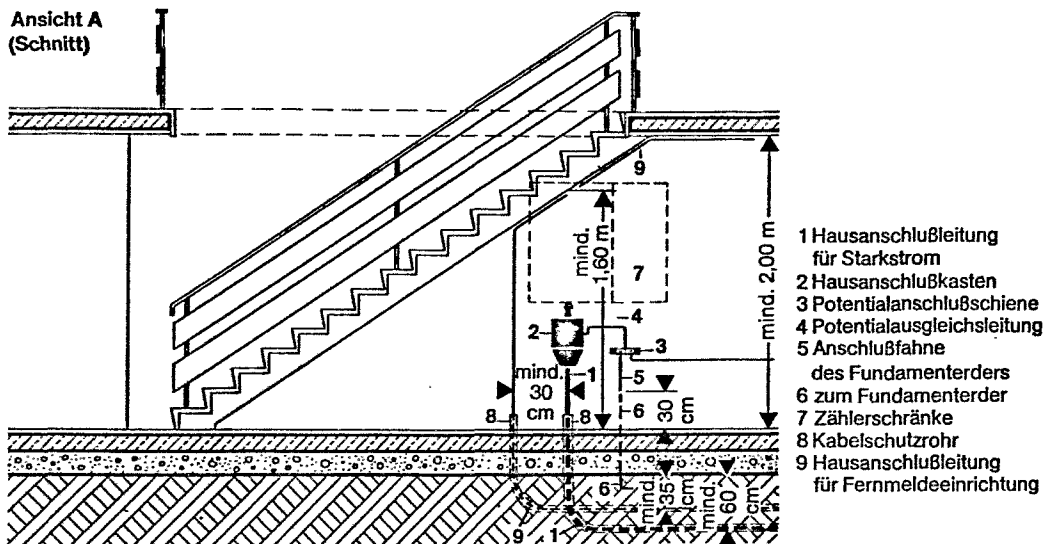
Hausanschluß unterhalb eines Treppenlaufes
